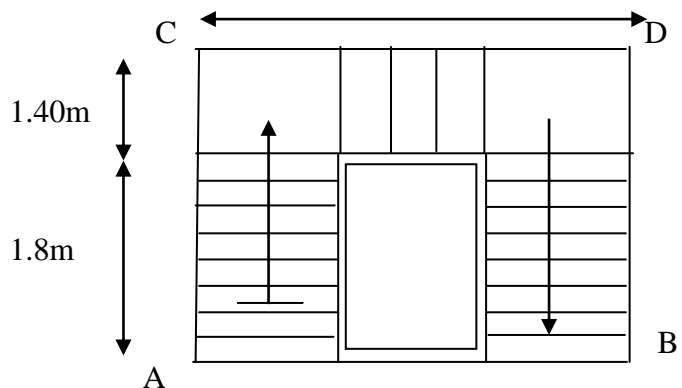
vue en plan de 1^{er} type d'escalier
